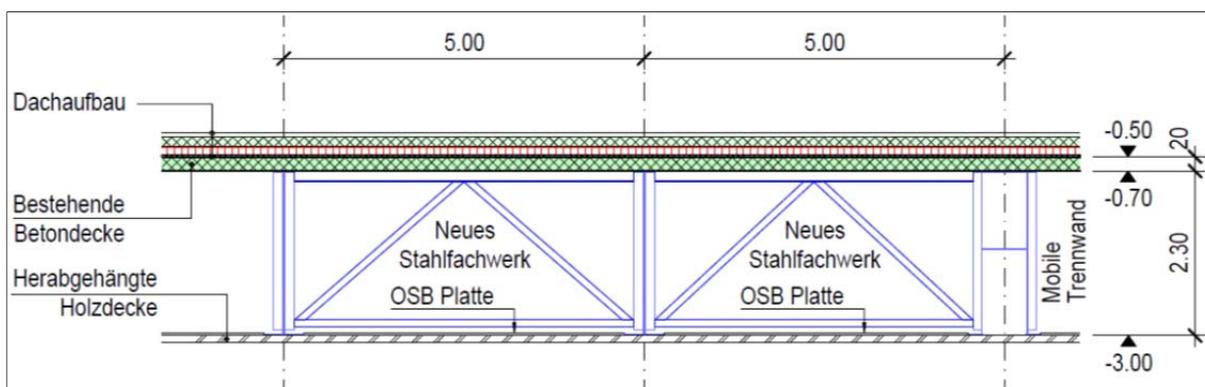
Teilquerschnitt Tragwerk mit zusätzlichen Stahlkonstruktionen
